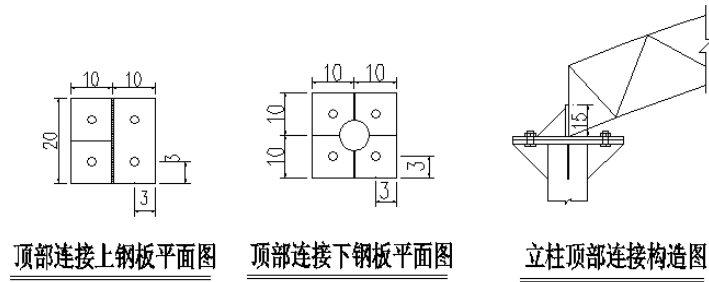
钢筋加工棚架立杆顶部钢板连接构造图
